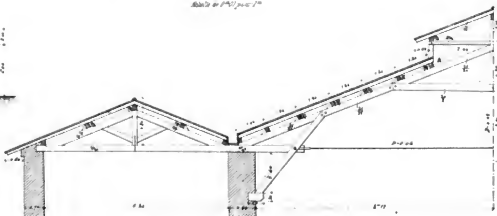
Detail d'un Pilier à 0^m01 p. 1^m
